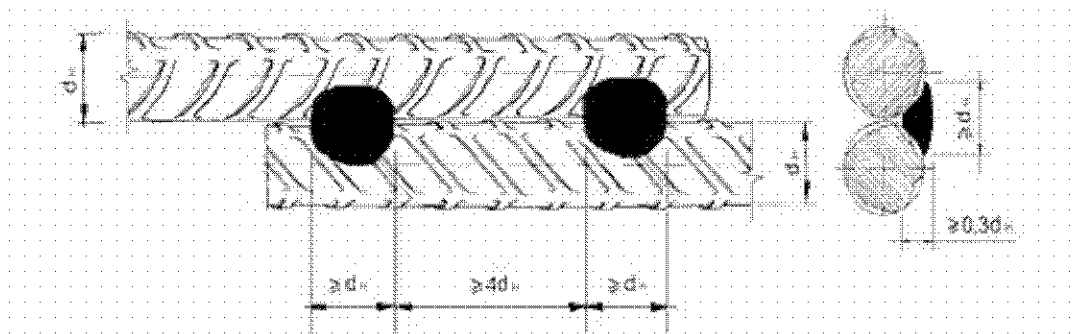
Конструкция нахлесточного соединения двух стержней арматуры с помощью сварки в среде защитных газов.
